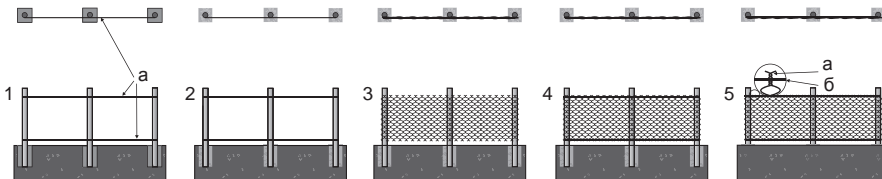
Альтернативный вариант монтажа сетки-рабицы: 1 — установка стоек (а — с бечевкой); 2 — бетонирование стоек; 3 — монтаж сетки-рабицы; 4 — протягивание проволоки по верхнему и нижнему краям сетки; 5 — скрутка (а — скрутка, б — проволока)
